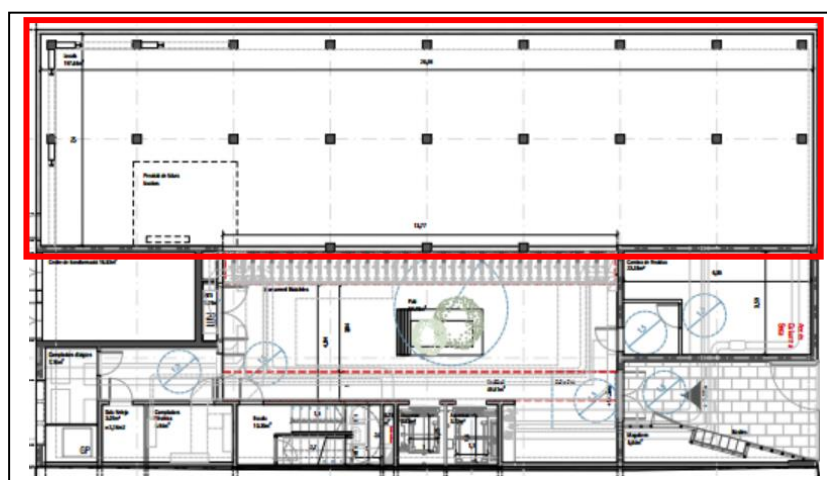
Ubicación en planta baja del recinto emisor del ensayo ACU-24-127617 (1).
